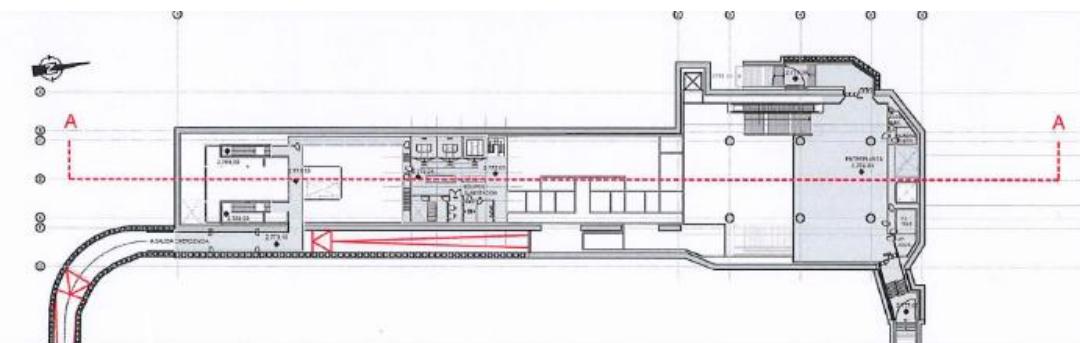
Plano en planta estación Jipijapa (EPMMQ, 2016)
